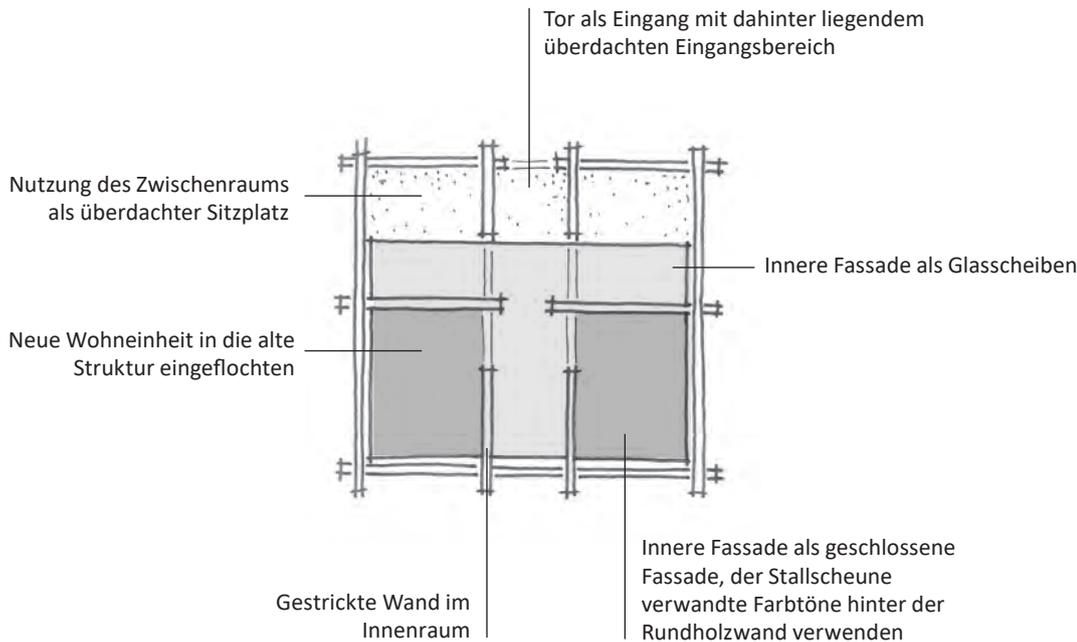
«Haus im Stall»-Prinzip bei gestrickten Stallscheunen. Systemdarstellung im Grundriss.
